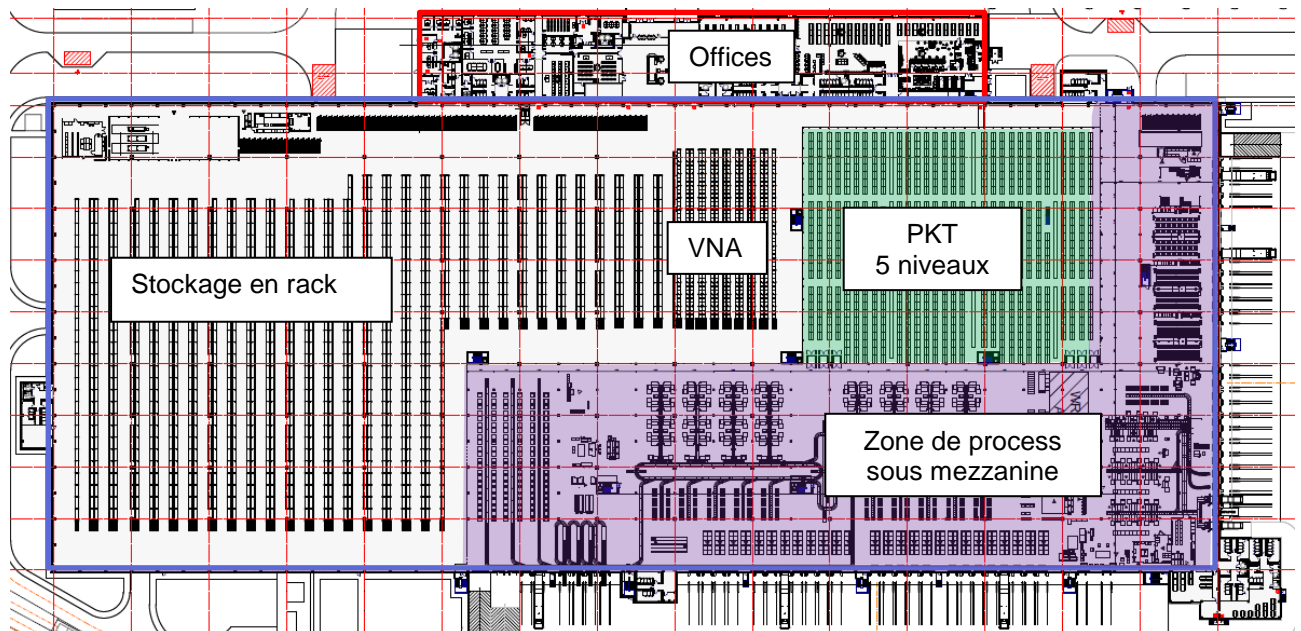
Plan du niveau RDC – P1 (+0,00 m)
